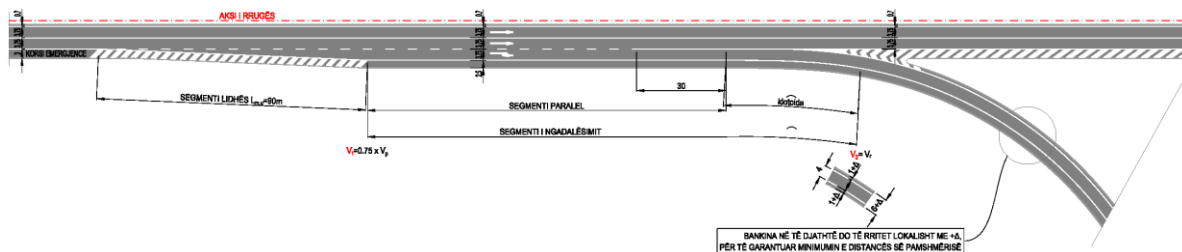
Korsia dalëse (e ngadalësim) – planimetri tip
